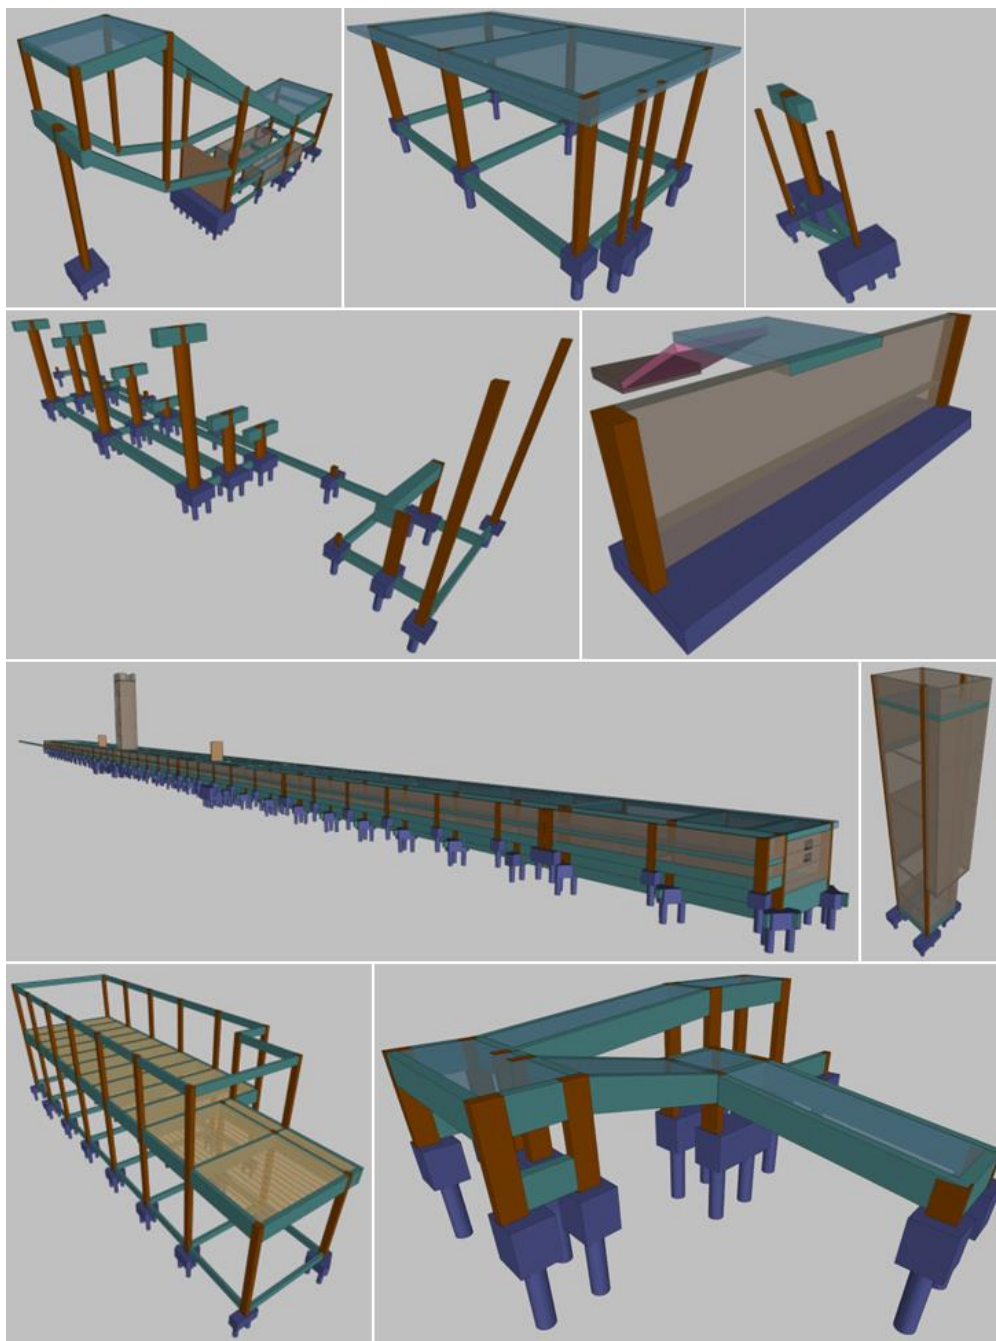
Imagens do projeto de estrutura de concreto da estação ferroviária
